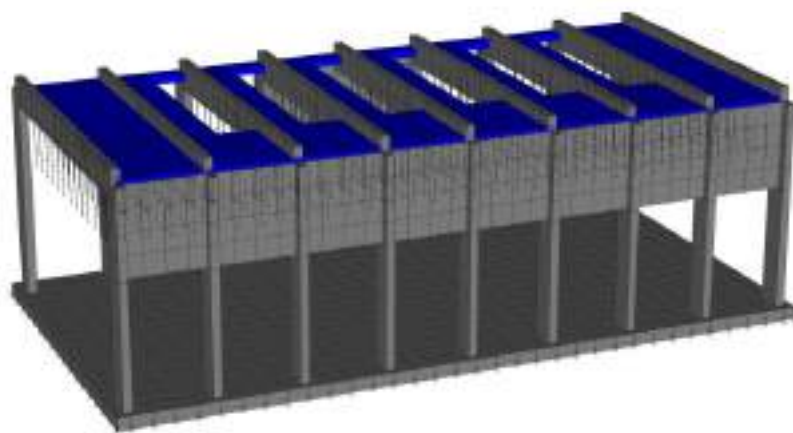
implementazione del carico pacchetto pavimentazione L3 (copertura) – $g_k = 2.00 \text{ kPa}$.
